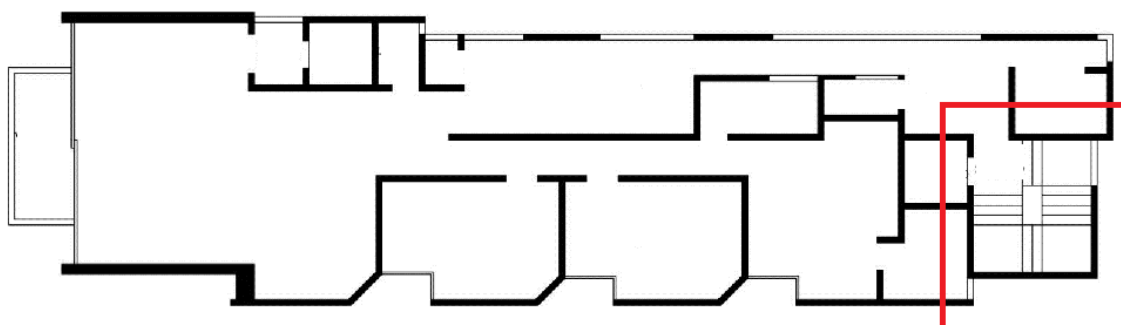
Planta do pavimento do edf. Arthur Vital, com escada exteriorizada central.
